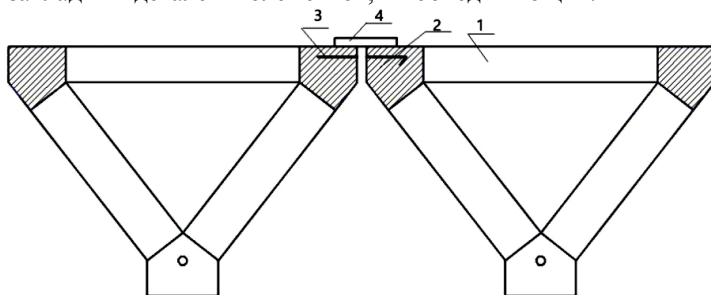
Вариант объединения балок в перекрытии с помощью закладных деталей: 1 – верхние полки балок; 2, 3 – сетки балок, укладываемые перед бетонированием; 4 стальная накладка
